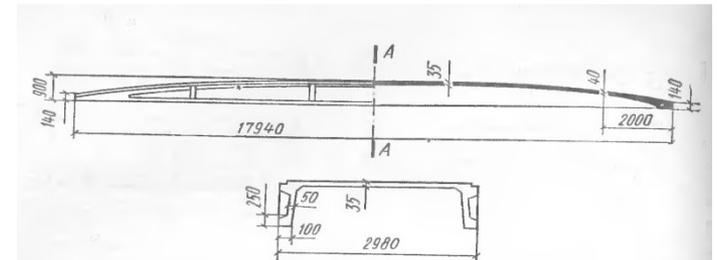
Схема крупноразмерной железобетонной сводчатой плиты КЖС размером 3×18 м
